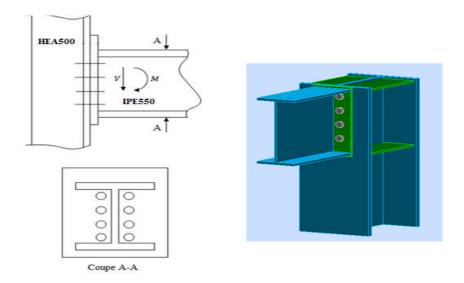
Représentation de l'assemblage poteau - poutre maitresse.
